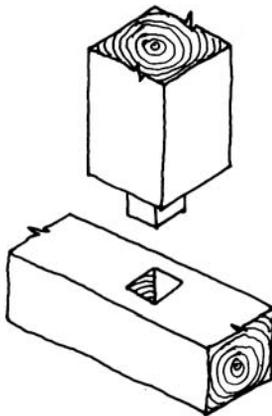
Ensamble de caja y espiga en el apoyo de un pilar sobre la solera.
